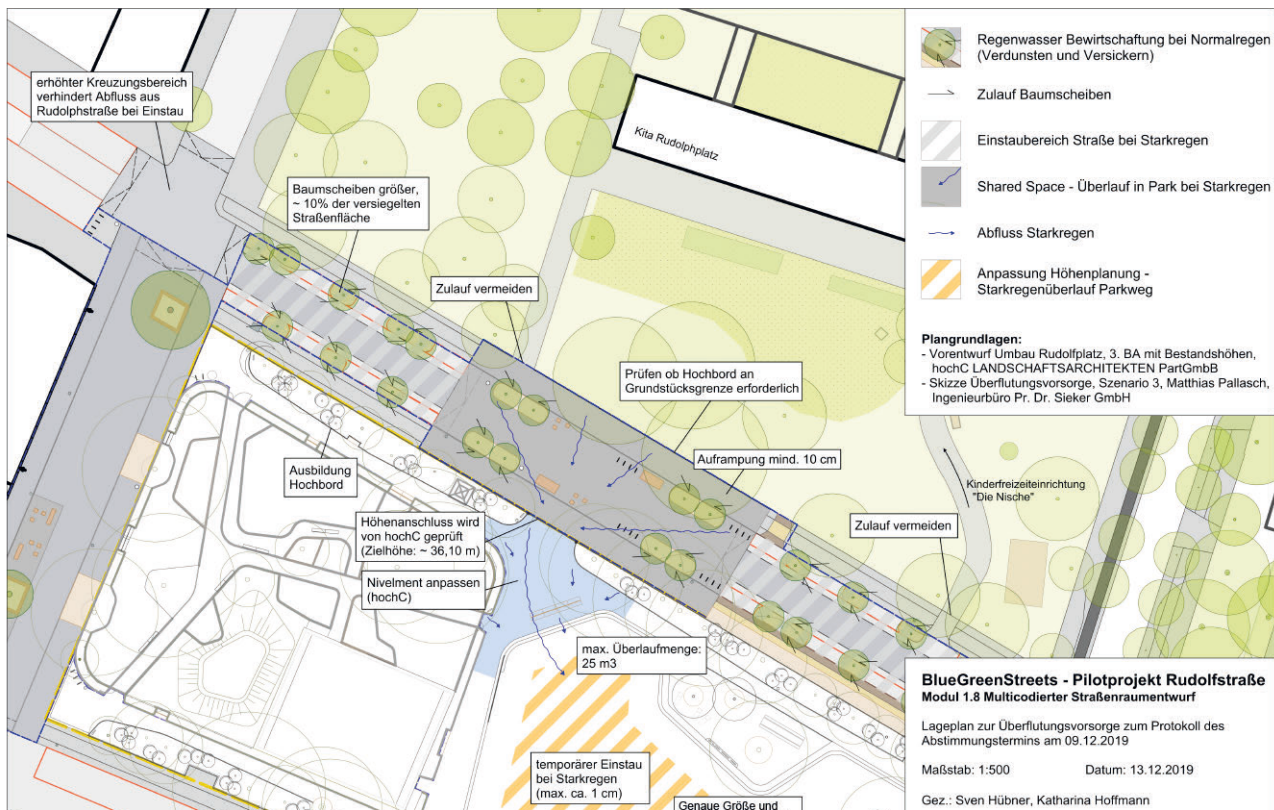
Lageplan zur Überflutungsvorsorge Rudolfstraße, Berlin, Quelle: BGS, bgmr.
